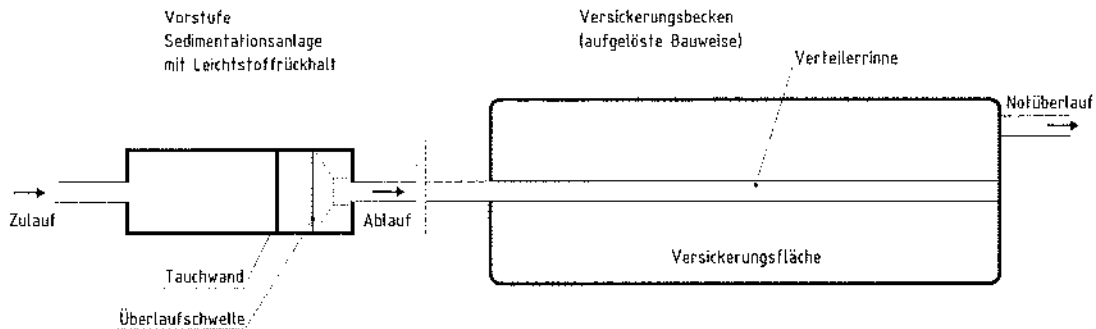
Versickerungsbecken mit Vorstufe, aufgelöste Bauweise
